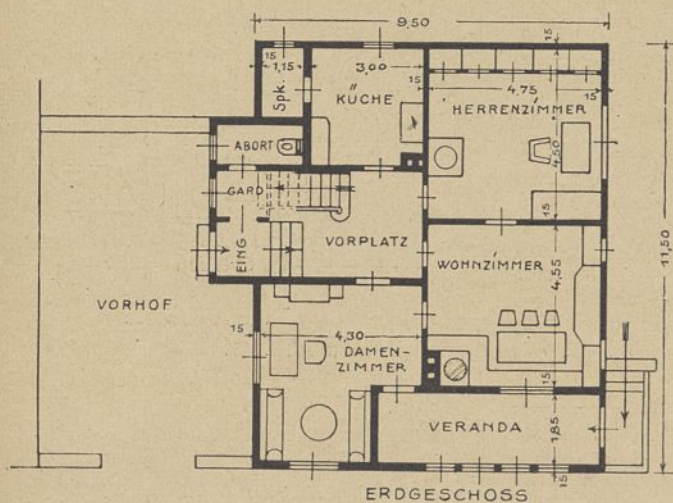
u. 49. Grundrisse zu Abb. 47.
